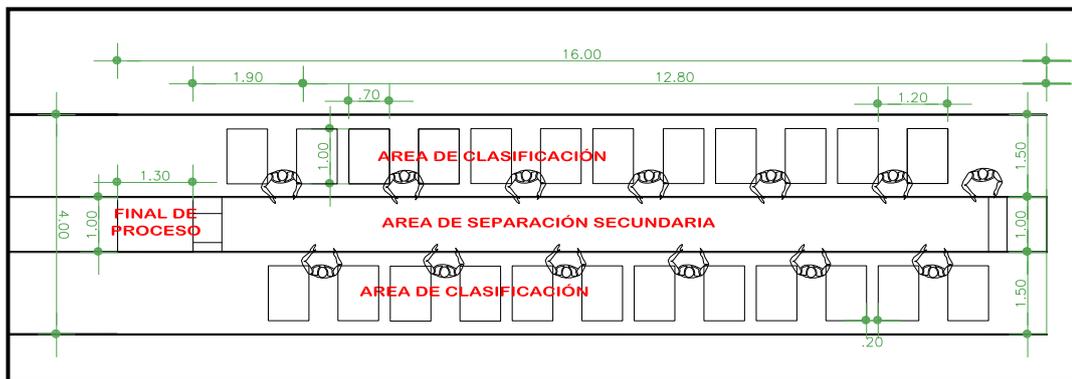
Vista arquitectónica específica del área de separación secundaria de la planta de reciclaje
